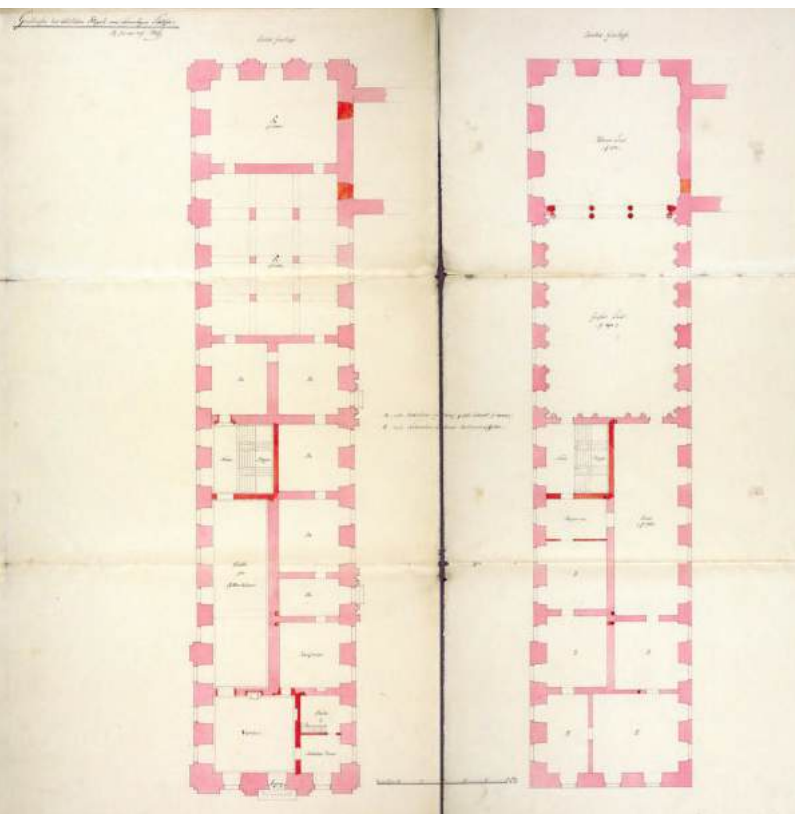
Franz Xaver Geier, Grundriss zum Umbau des Nordflügels, 1837.
